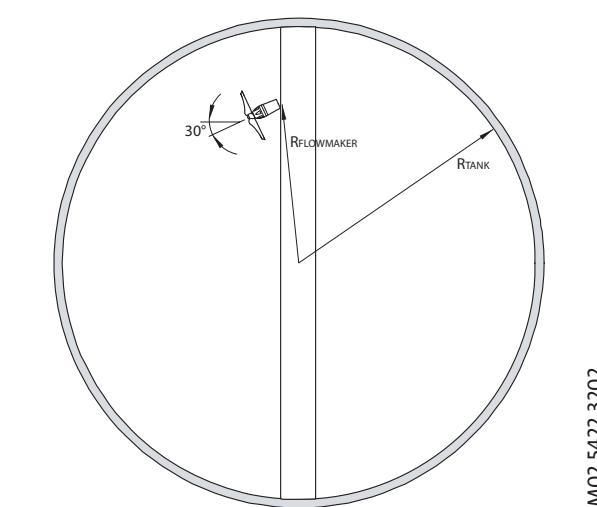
Схема монтажа образователя потока в цилиндрическом резервуаре
